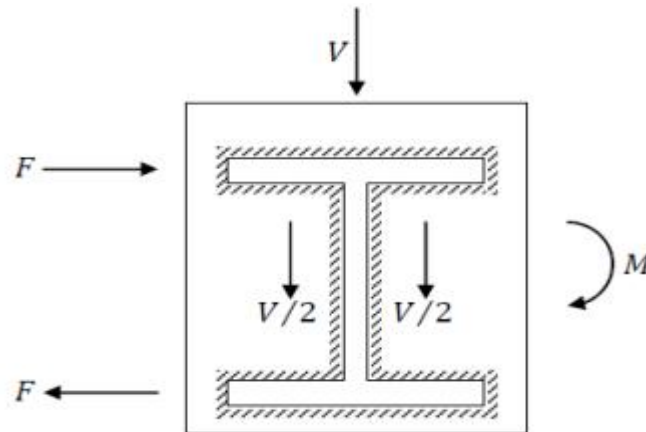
Assemblage par soudure poutre-platine.
